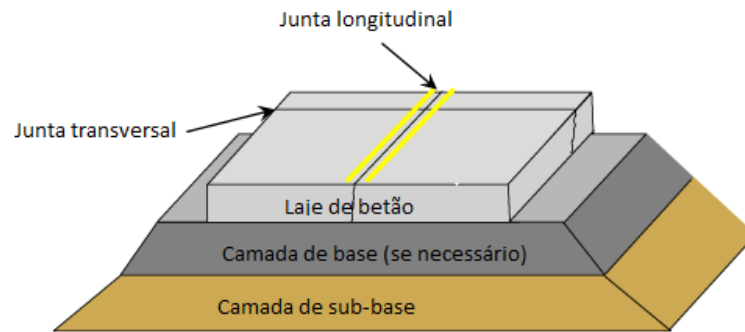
Constituição do pavimento rígido (fonte: Adaptado de Khan, 2016).
